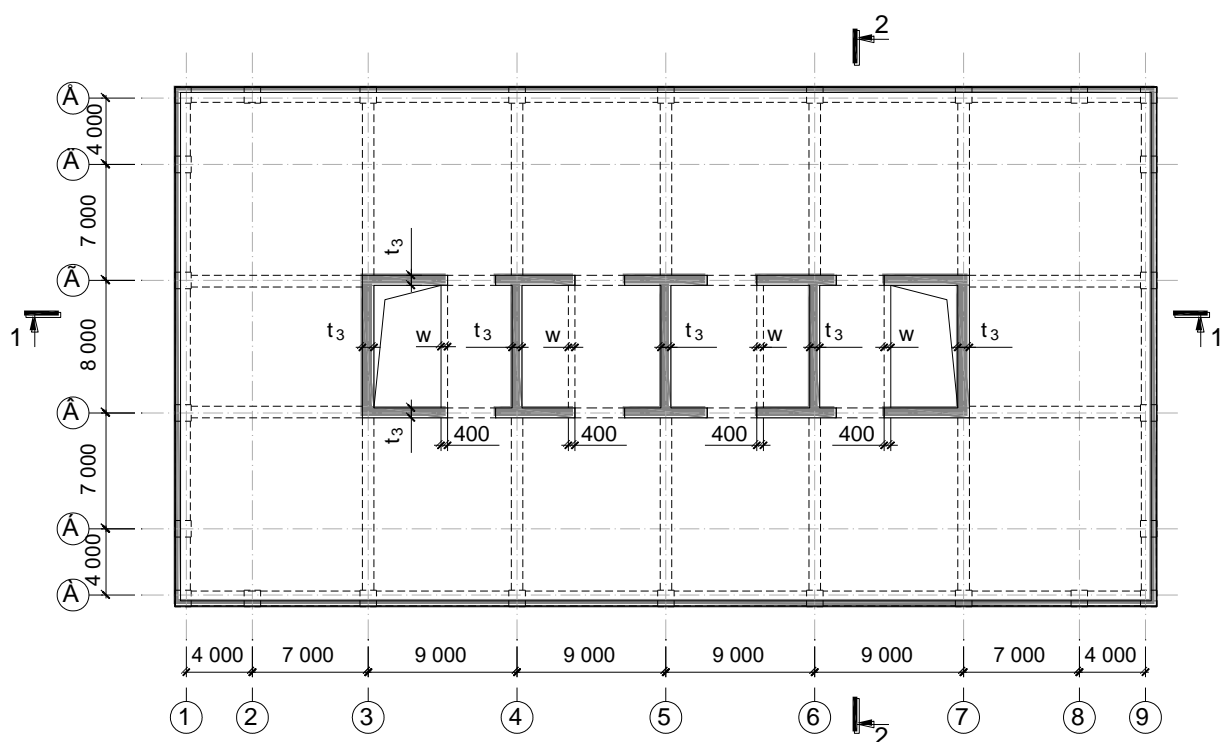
Схематические планы подземных и надземных этажей здания
